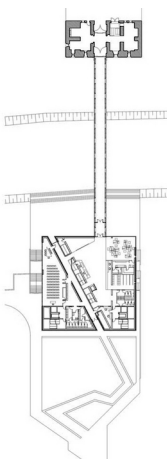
Plan przyziemia. Elewacja frontowa.
